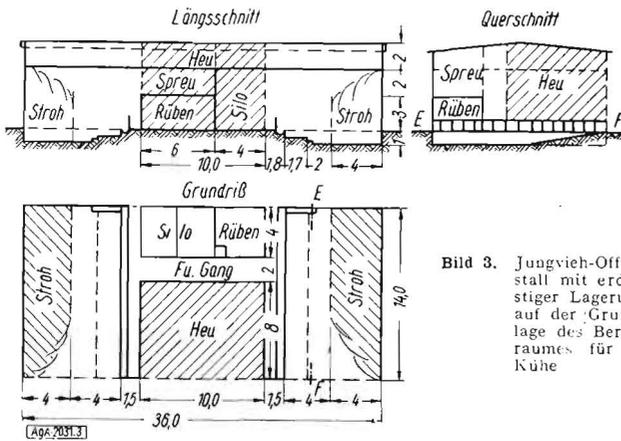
Jungvieh-Offenstall mit erdlastiger Lagerung auf der Grundlage des Bergeraumes für 90 Kühe
